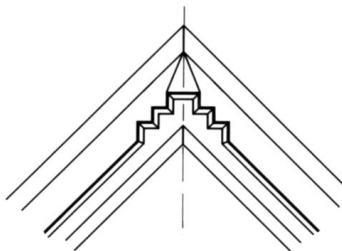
Устройство кремальер для обстреливания мертвого угла.
